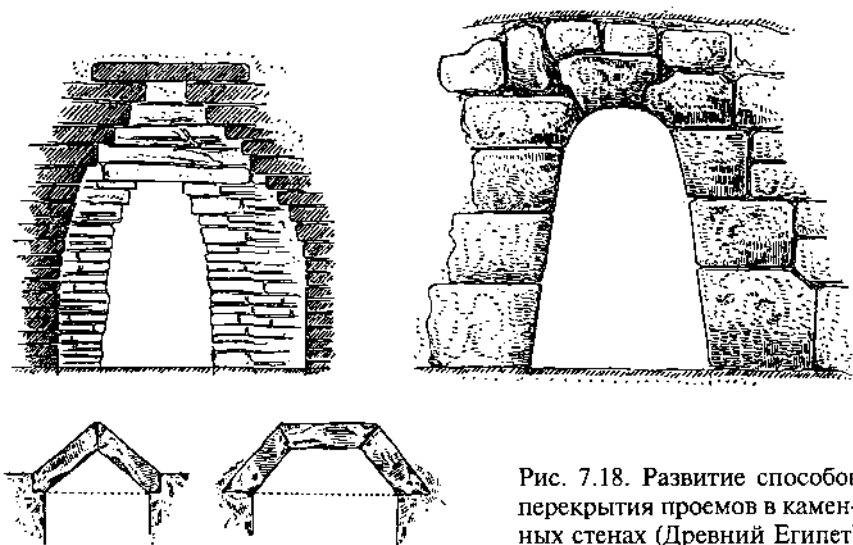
Развитие способов перекрытия проемов в каменных стенах (Древний Египет)
